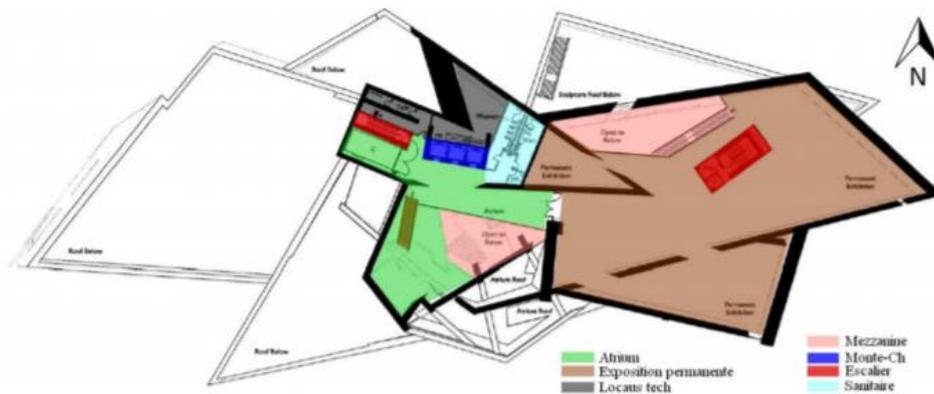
Plan 3ème étage. Source : www.archdaily.com, édité par l'auteur
